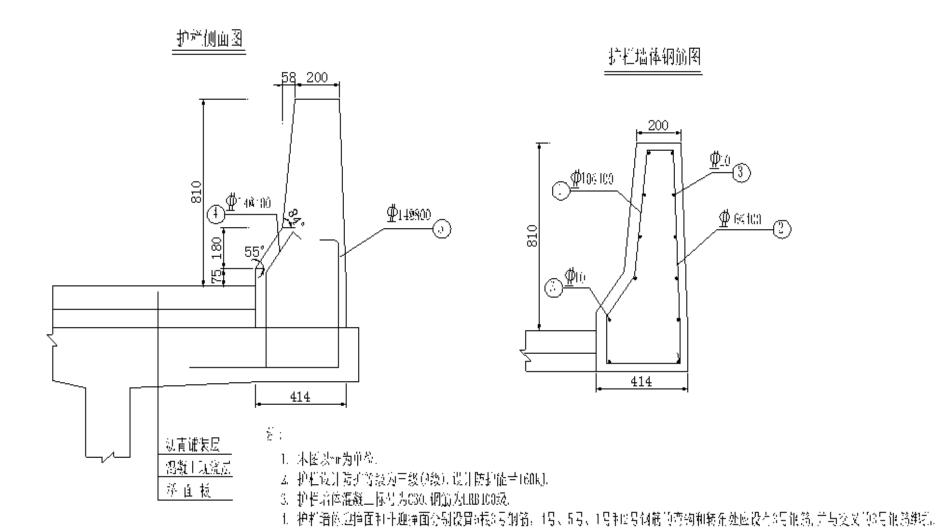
三 (A) 级 F 型桥梁混凝土护栏设计示例 (尺寸单位: mm)
